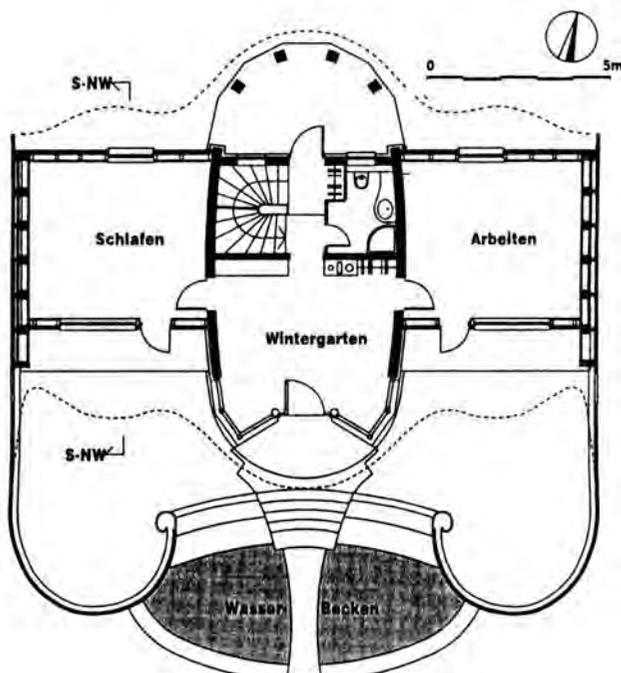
Wohnhaus Bad Schwalbach, Grundriss des Erdgeschosses, aus /150/
